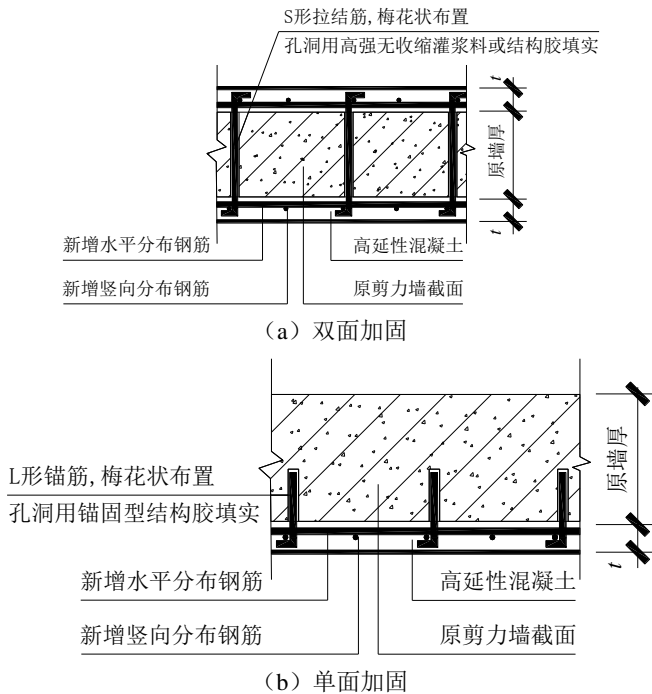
配筋高延性混凝土面层加固钢筋混凝土剪力墙构造
